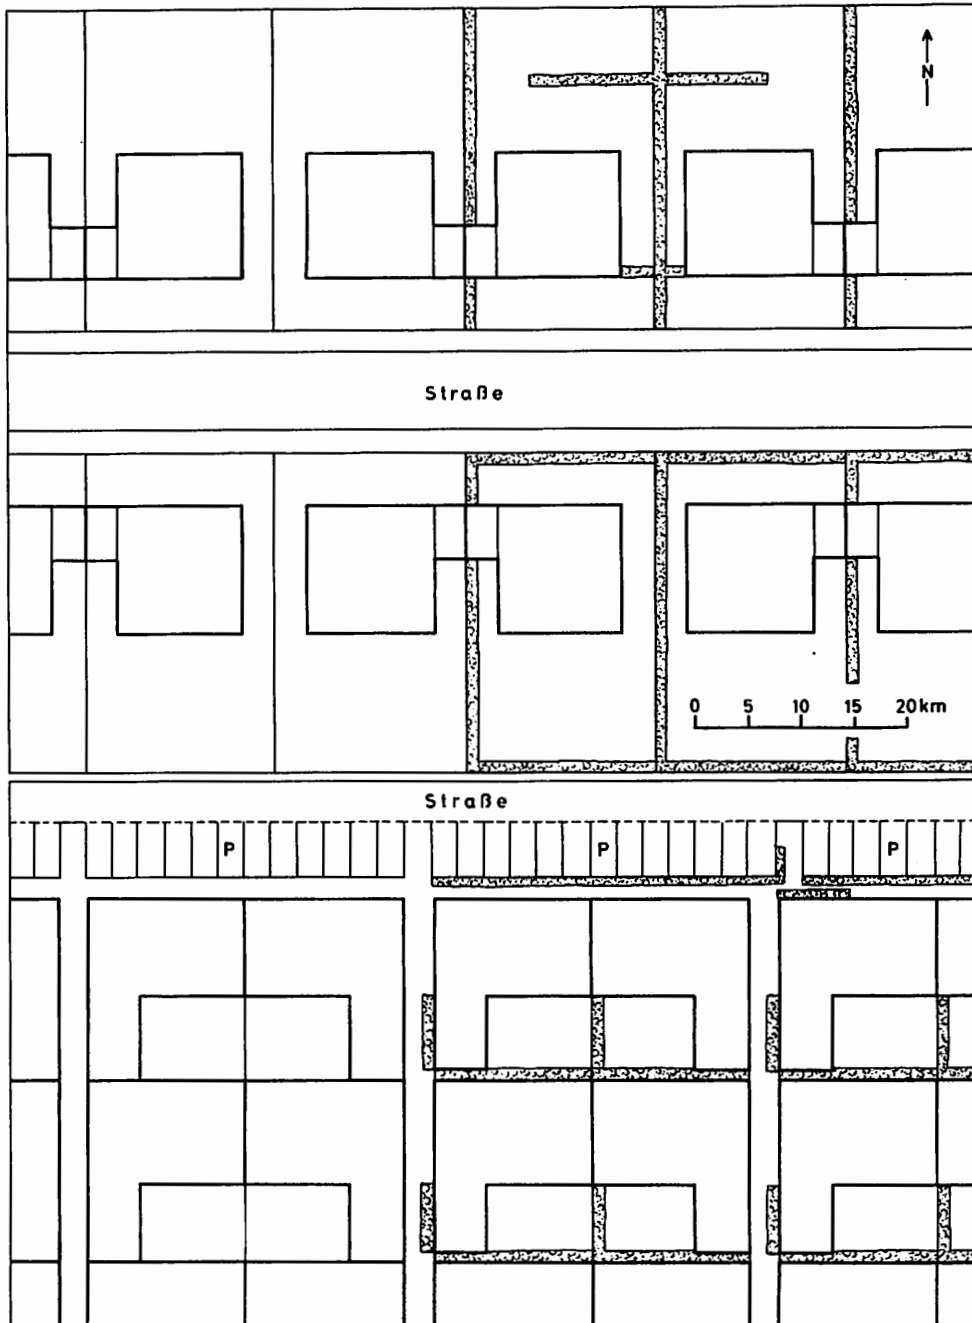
Typische Einfamilienhäuser in offener Bauweise (oben) und ein Beispiel für eine Teppichbebauung (unten), links ohne, rechts mit einem System von Hausschutzhecken.
